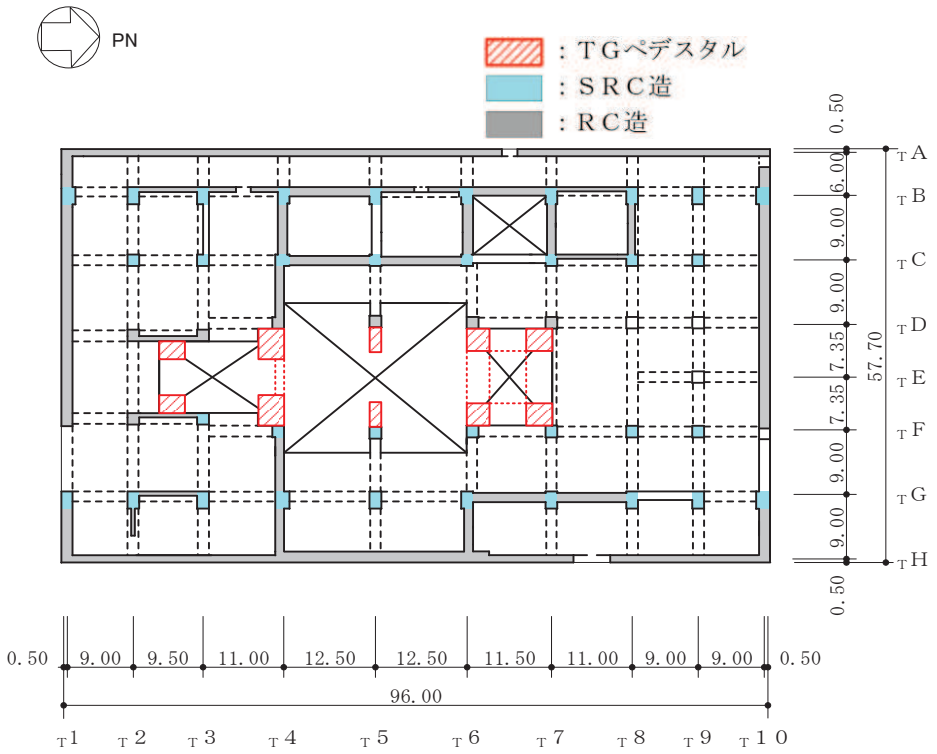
(1) タービン建屋の概略平面図 (0.P.*0.8m)
